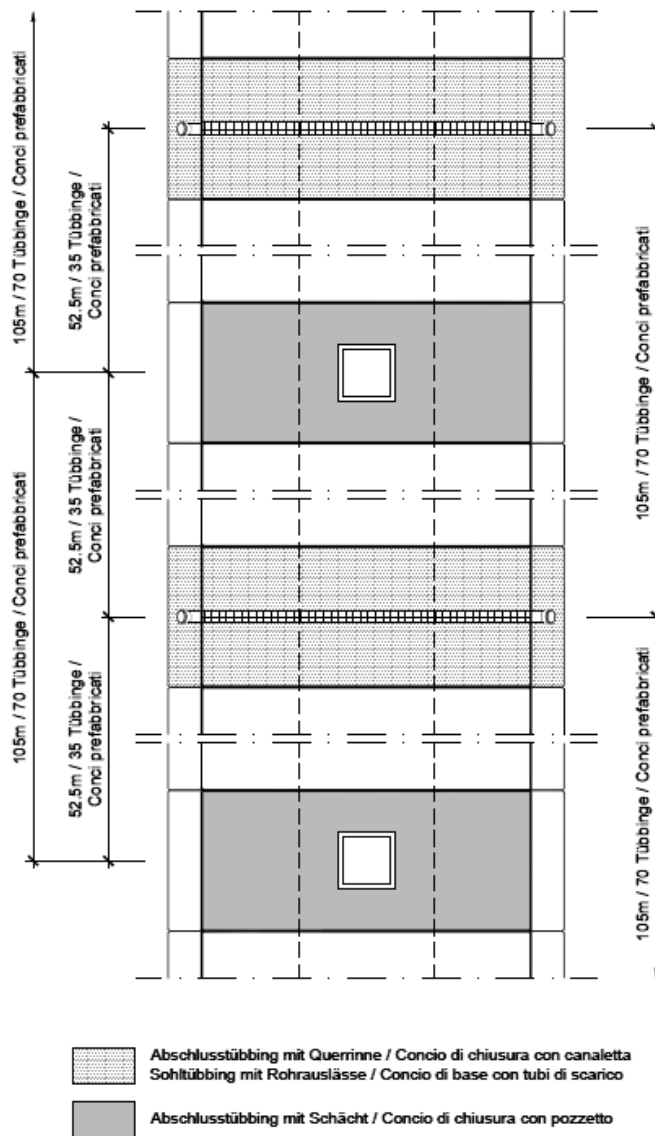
Planimetrisches Schema des Abschlusstübbings.
